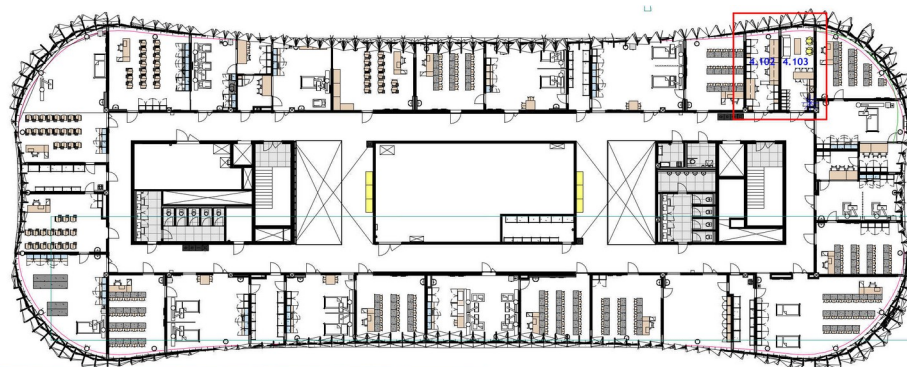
Půdorys 1.NP (červeně jsou vyznačeny posuzované místnosti)
